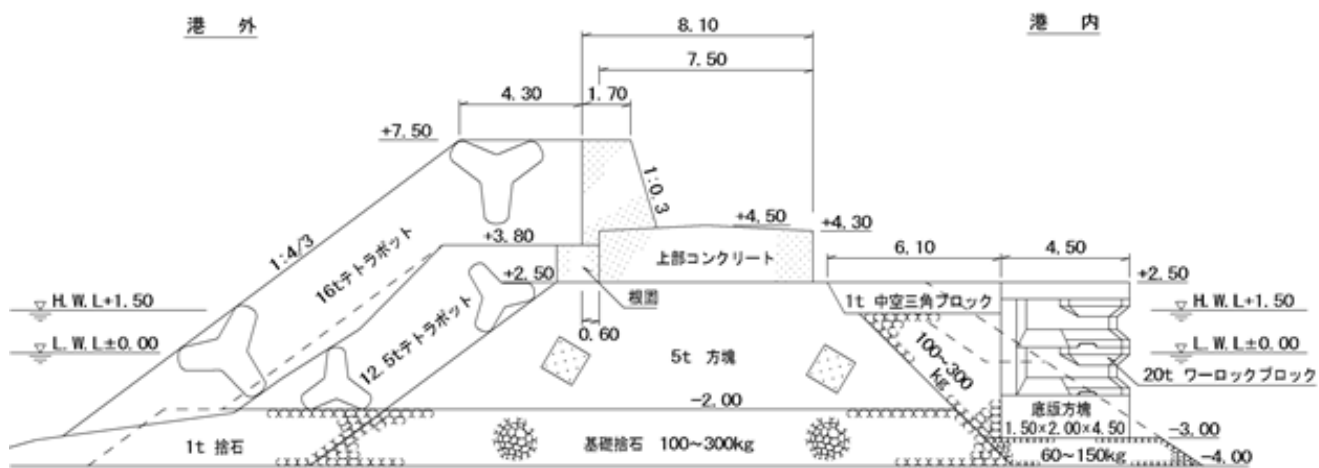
No.31 大洗港区\_第1ふ頭 A-2 物揚場 (-4.0m) の断面図 (被災前)
